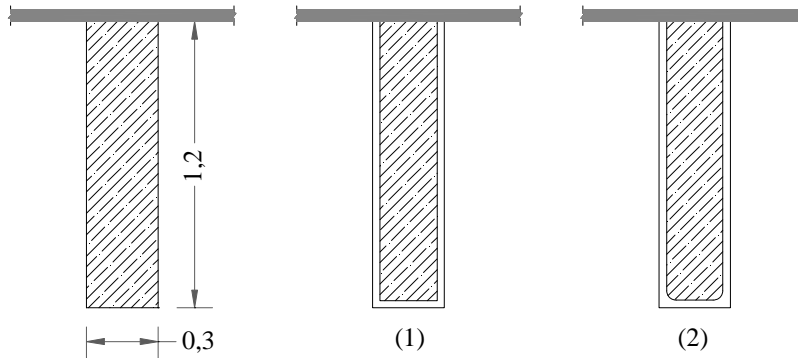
Secciones residuales ante la acción del fuego para la viga V2. Las Medidas están dadas en Metros
